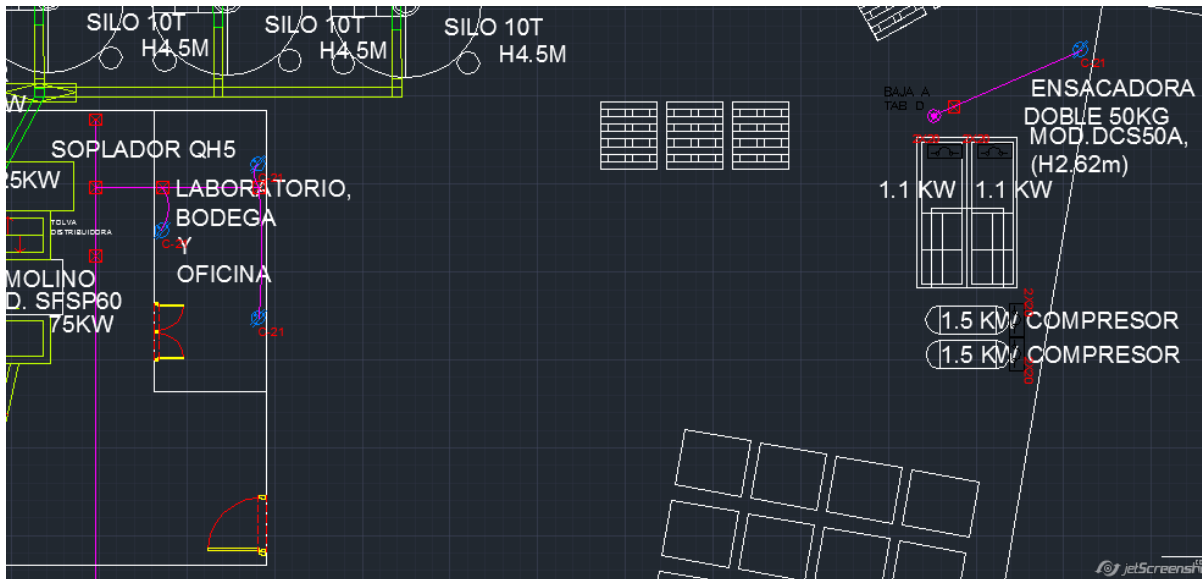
Ubicación de contactos, cuarto de máquinas planta baja.
